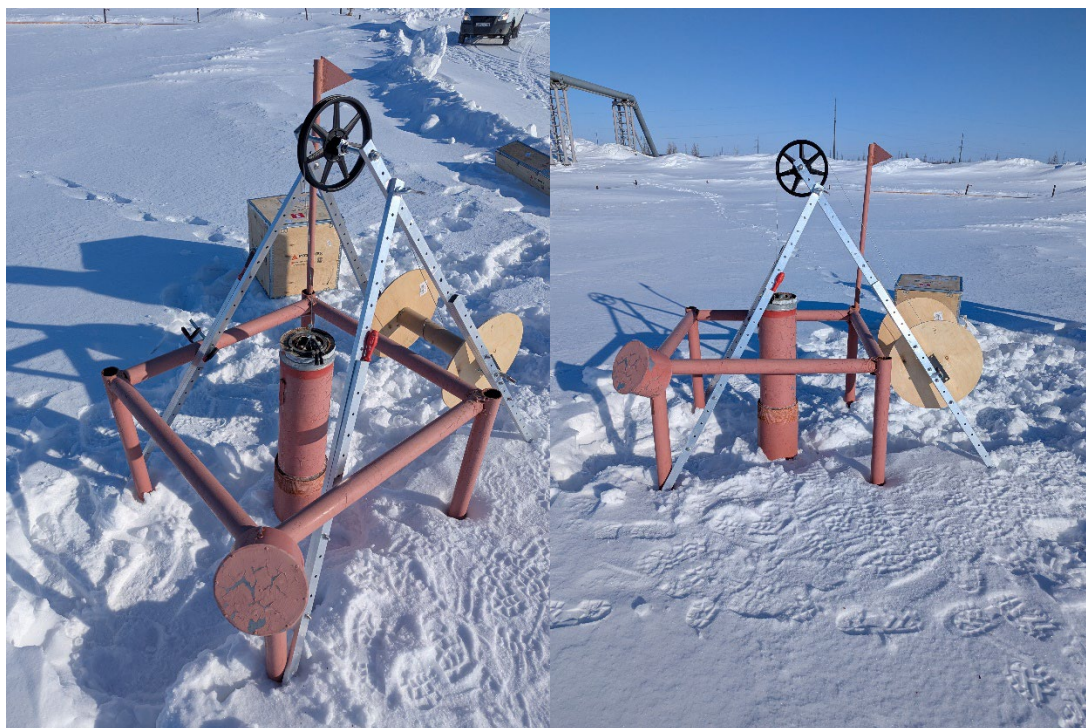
Фото приспособлений для установки тяжелых ИТМ2
